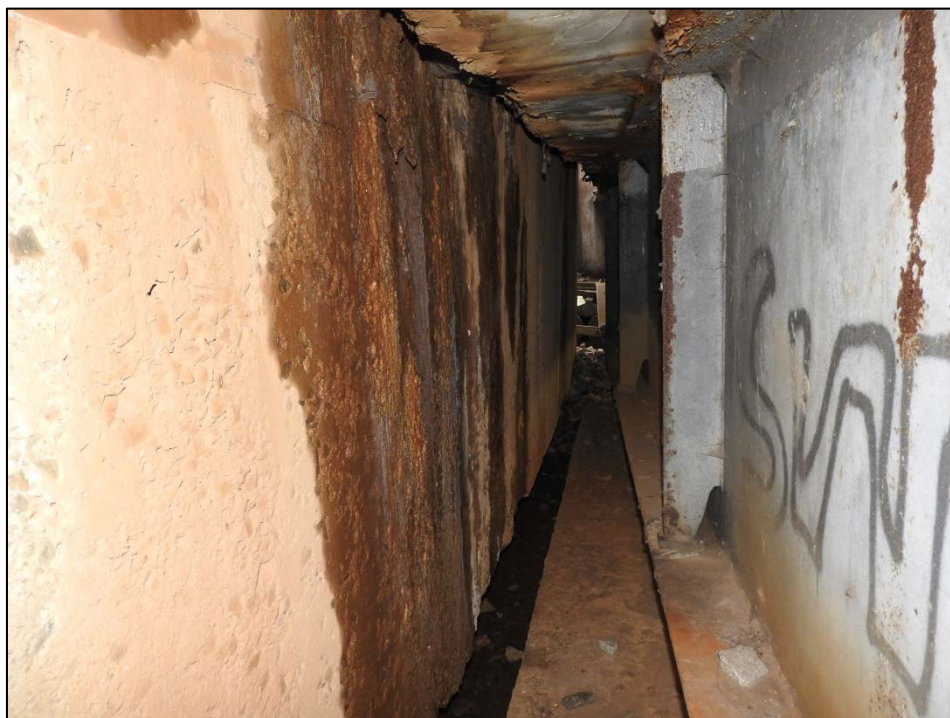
Dilatační spára mezi ocelovou konstrukcí K 02 a předpjatou konstrukcí K 03 na pilíři P 04 (pohled zleva)
